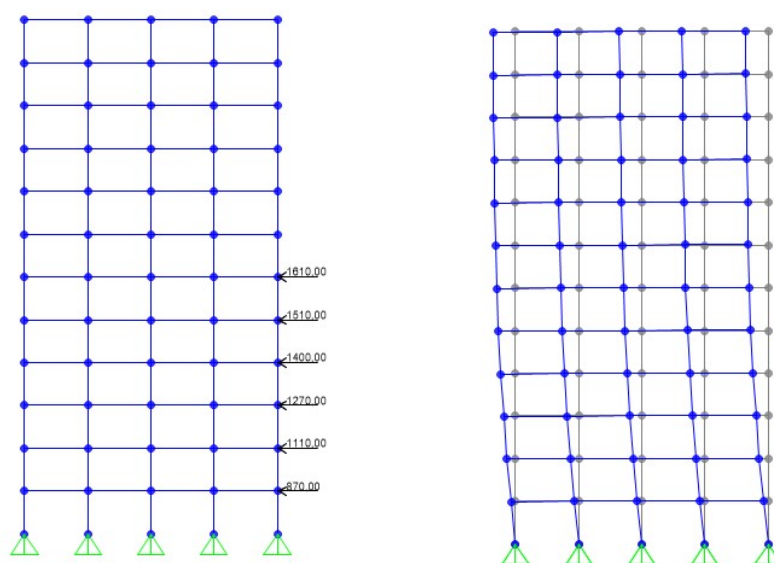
Pórtico I: viento longitudinal. Cargas expresadas en kg y su estructura deformada
